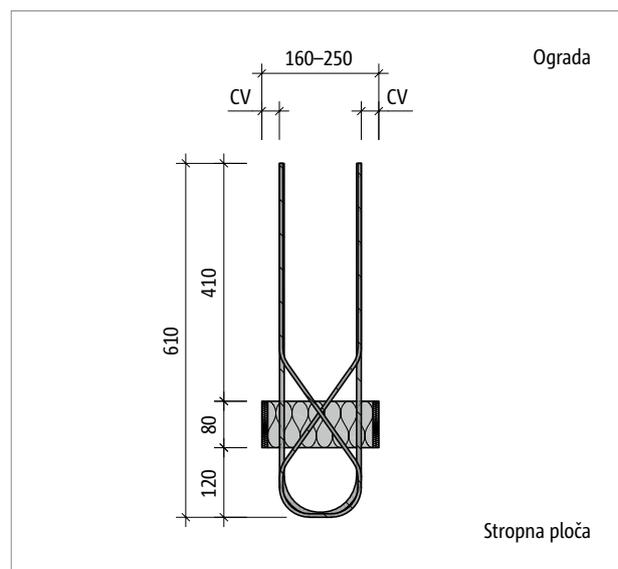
Schöck Isokorb® XT tip AP: Presjek
